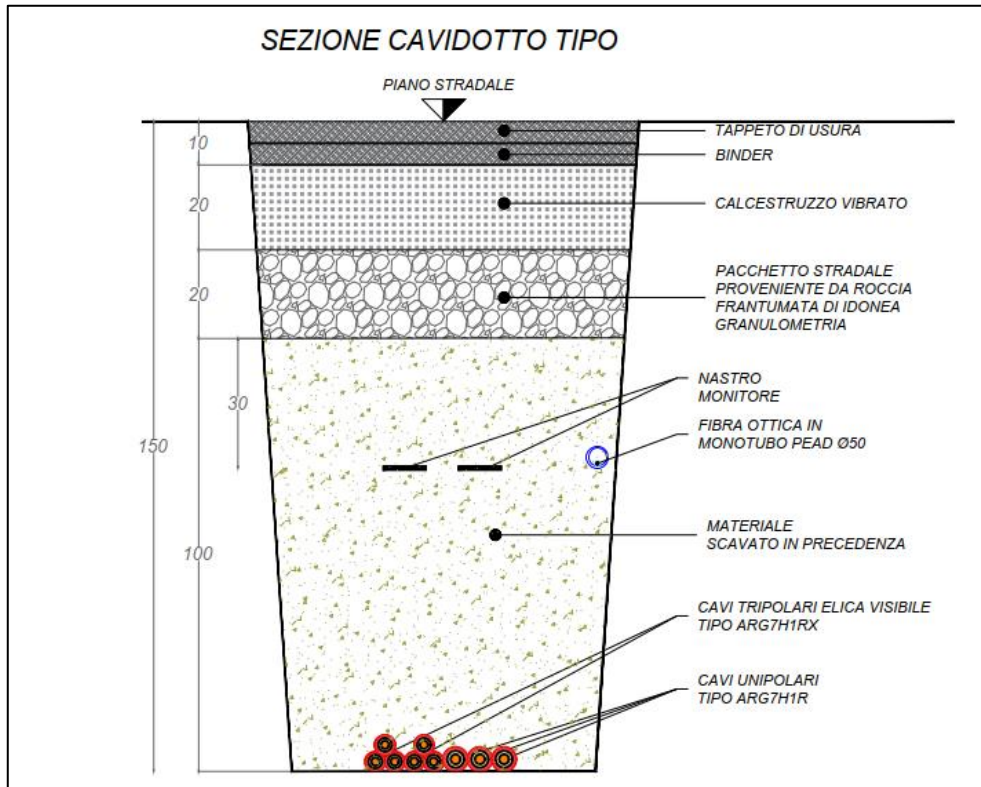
Sezione di posa cavidotto MT a 30 kV – su strada asfaltata
